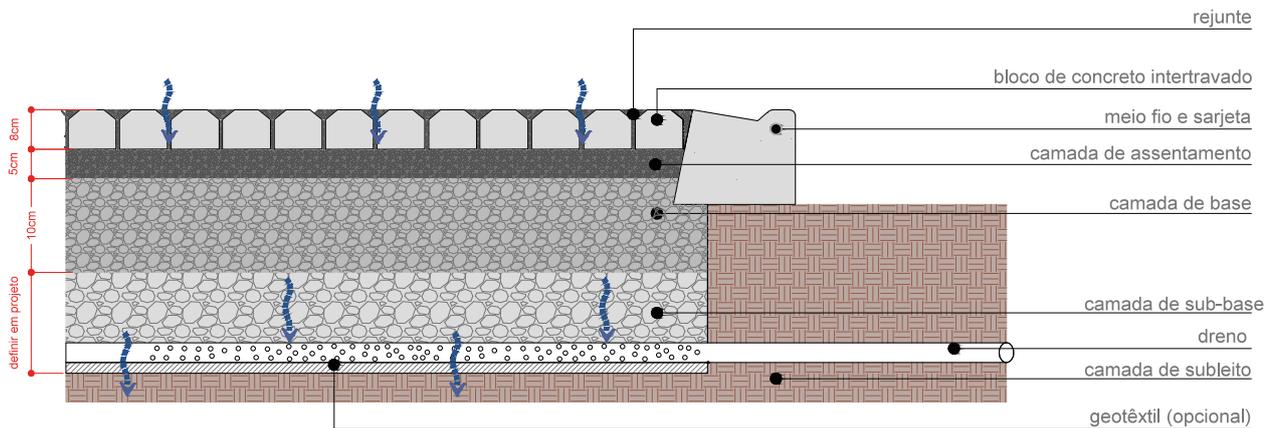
Esquema técnico de pavimento intertravado permeável com infiltração parcial no solo.
